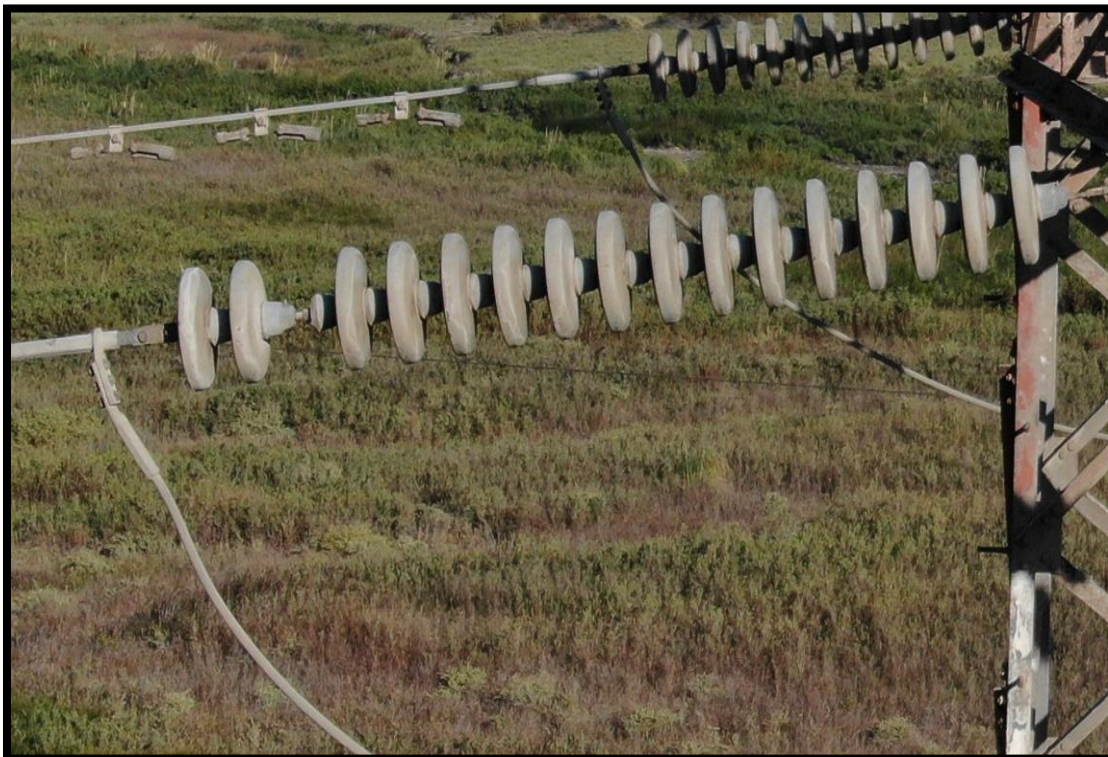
Aislador quebrado entrada fase inferior derecha.
